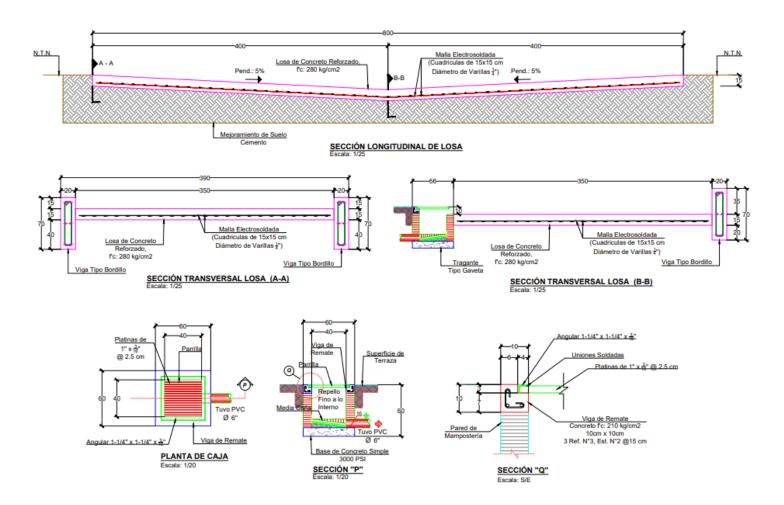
Propuesta de mejora, detalle de drenaje y planta de columnas metálicas
